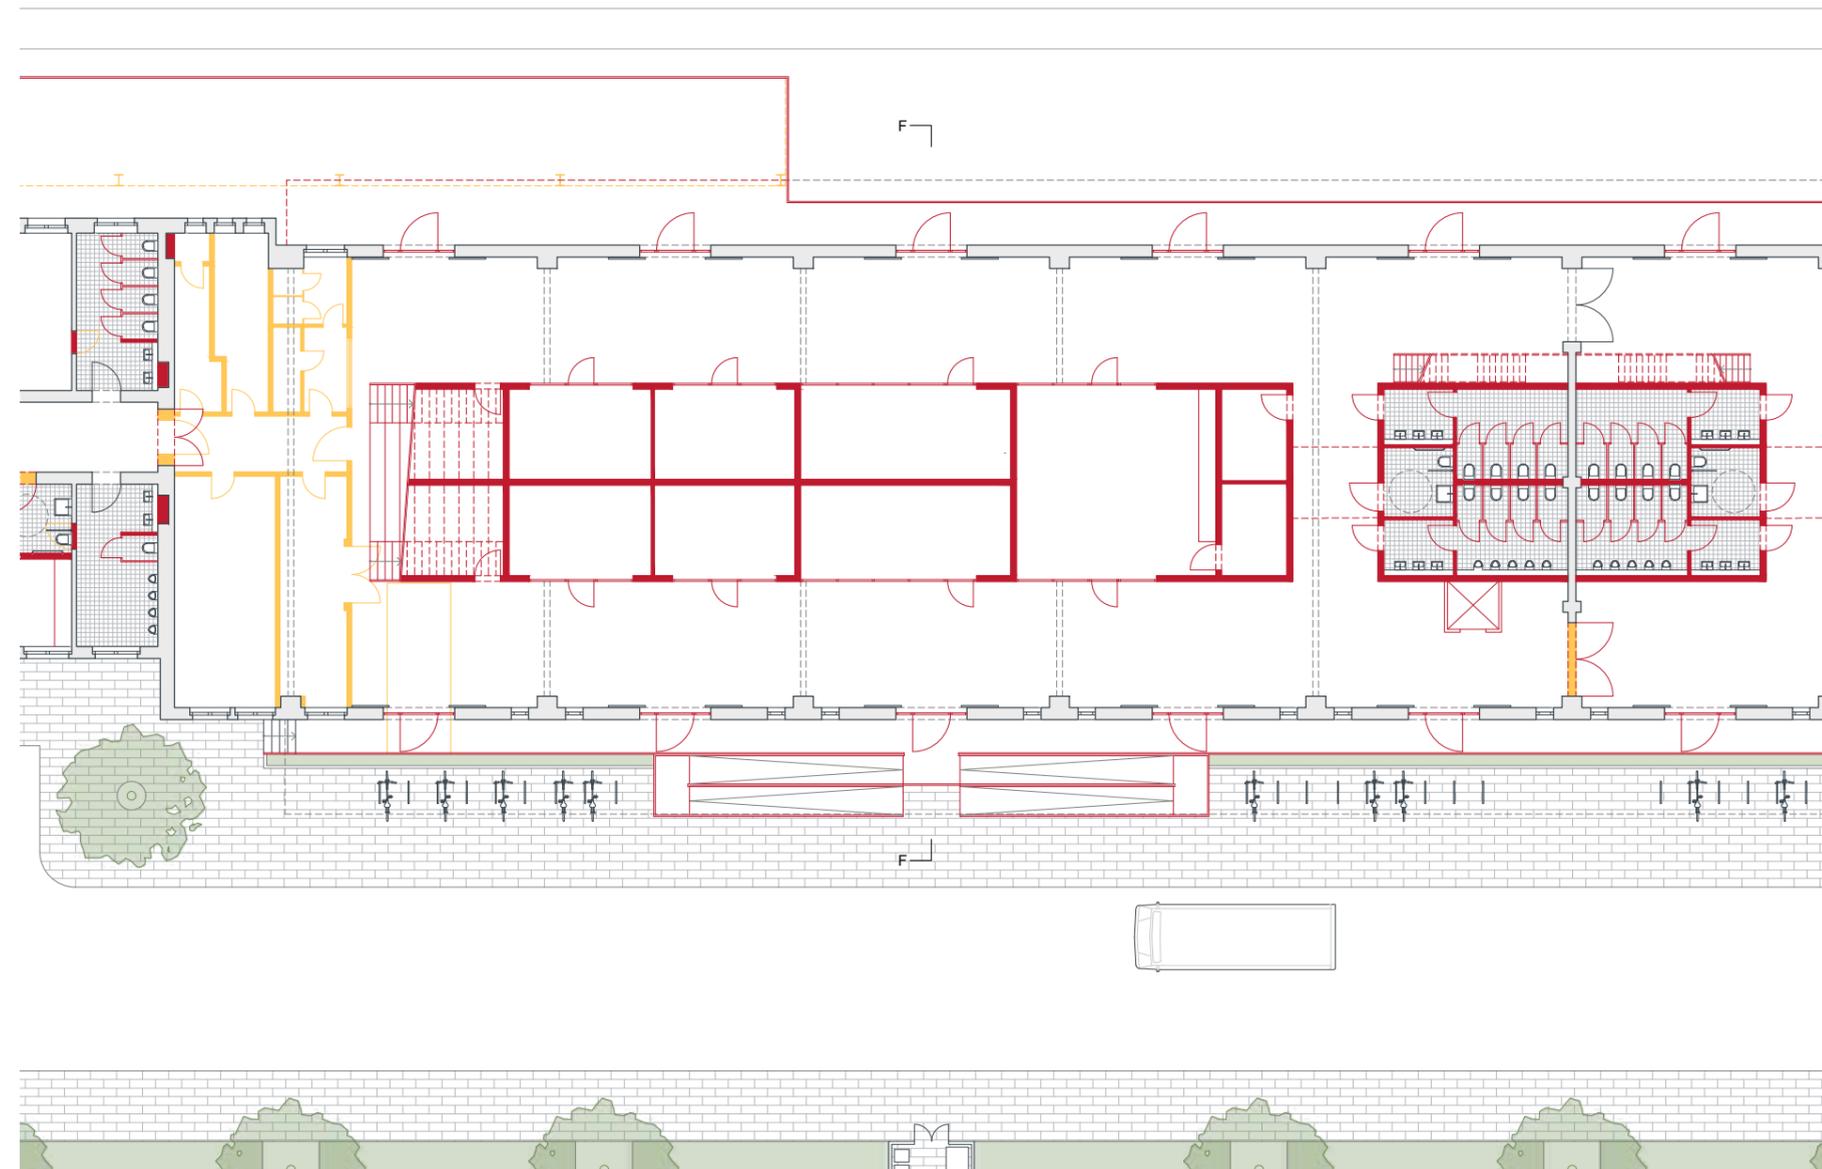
Stückgutschuppen: Co-Working-Space, Halle 1, Erdgeschoss M 1:250
